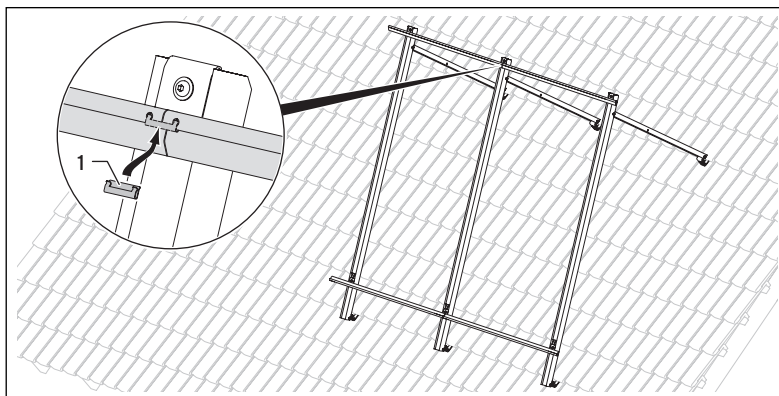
Spojení montážních kolejnic (s spojovacím dílem kolejnic)
